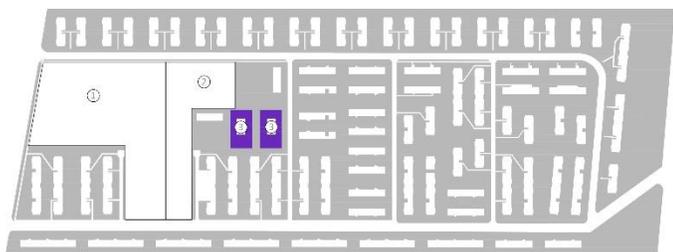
Equipamiento Marta Brunet. Fuente: Elaboración propia.
